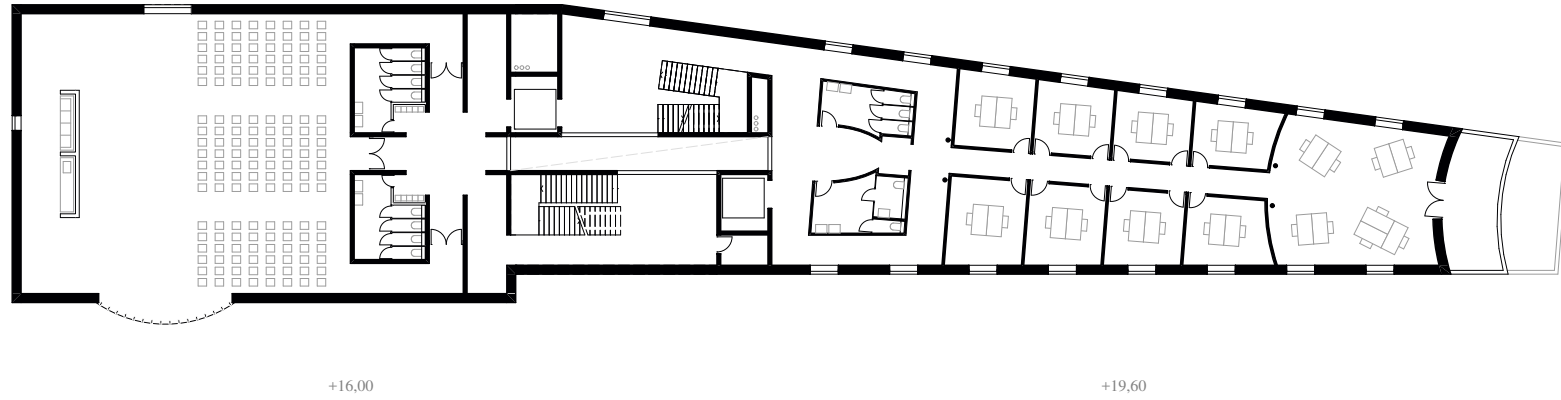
/ Grundriss der Ebenen "+16,00" und "+19,60" M 1:400 (Plan erstellt von PB)
